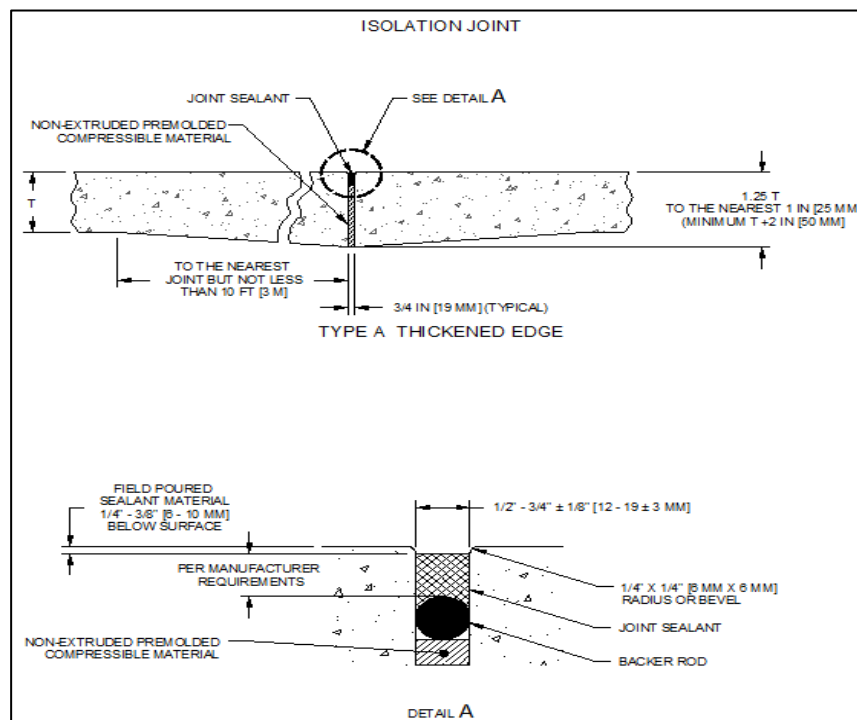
Esquema de las juntas de dilatación de un pavimento de concreto hidráulico.
